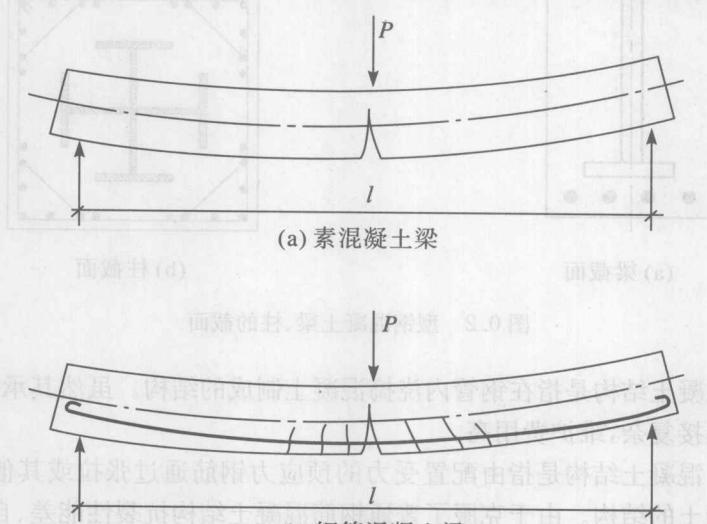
素混凝土梁和钢筋混凝土梁的破坏情况
